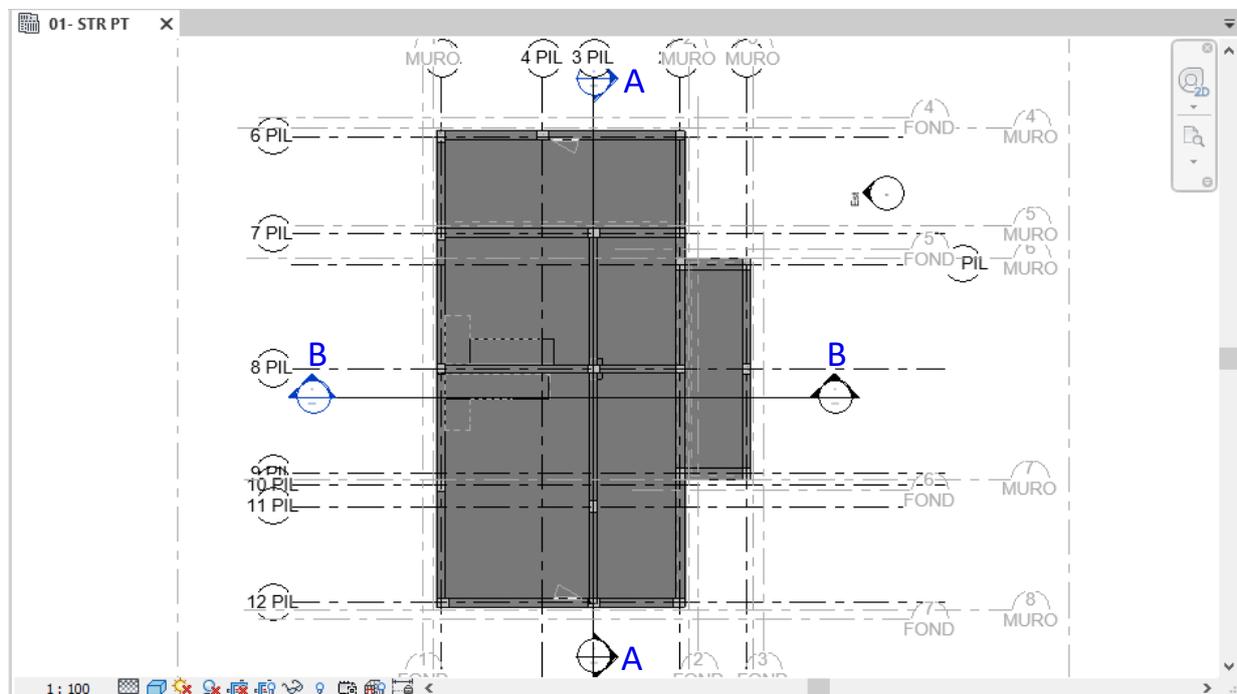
Vista 01-STR PT: Pianta strutturale piano terra modello strutturale
